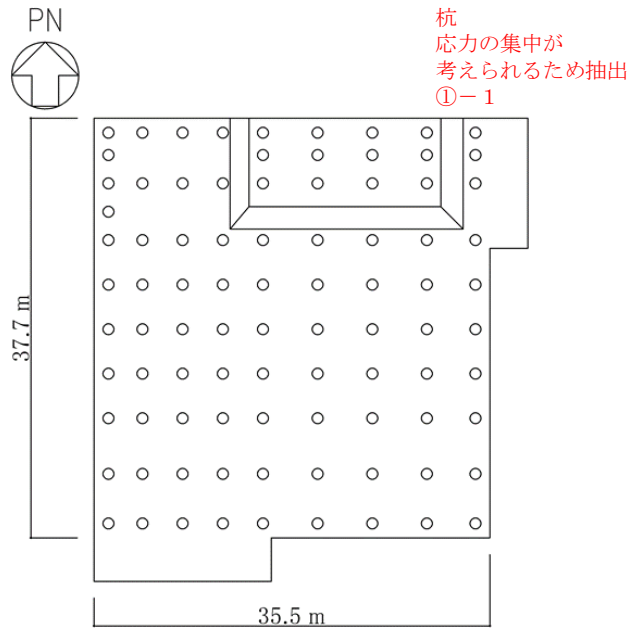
緊急時対策所建屋の概略平面図 (EL. 20.8m)
